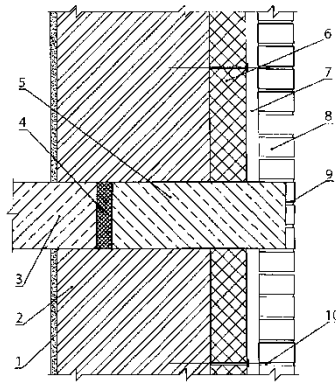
Конструктивна схема збірної системи з несучими зовнішніми стінами. 1 - внутрішня штукатурка; 2 - несуча стіна; 3 - плита перекриття; 4 - додатковий теплоізоляційний вкладиш; 5 - залізобетонний консольний пояс через 3-4 поверхи; 6 - шар теплової ізоляції; 7 - повітряний вентиляційний прошарок; 8 - опоруджувальний шар із цегли або стінових дрібноштучних каменів з вентиляційними отворами у вертикальних швах; 9 - клінкерна фасадна цегла; 10 - металевий зв'язок із фіксатором теплоізоляційного шару.
